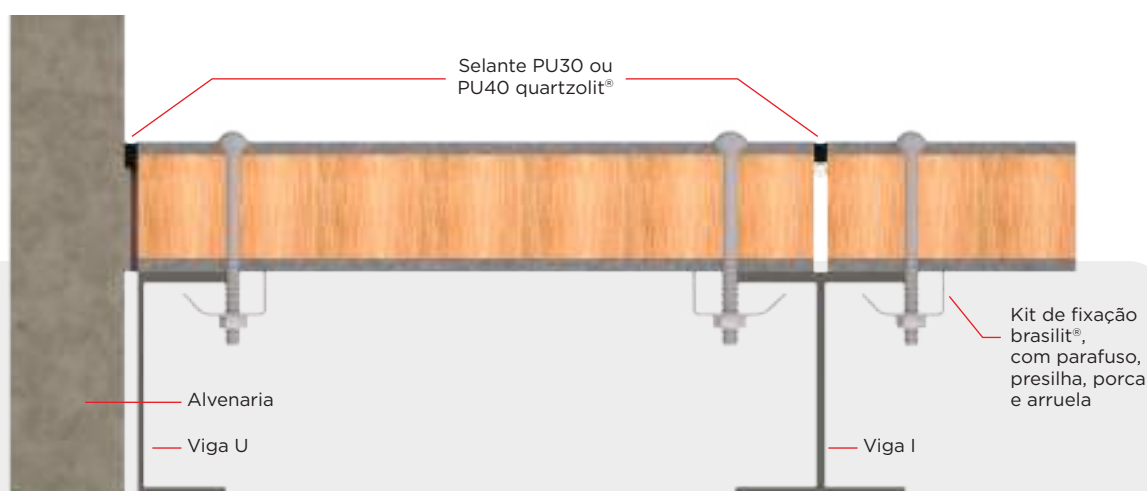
Detalhe da fixação do painel masterboard brasilit sobre viga de aço pesado.
